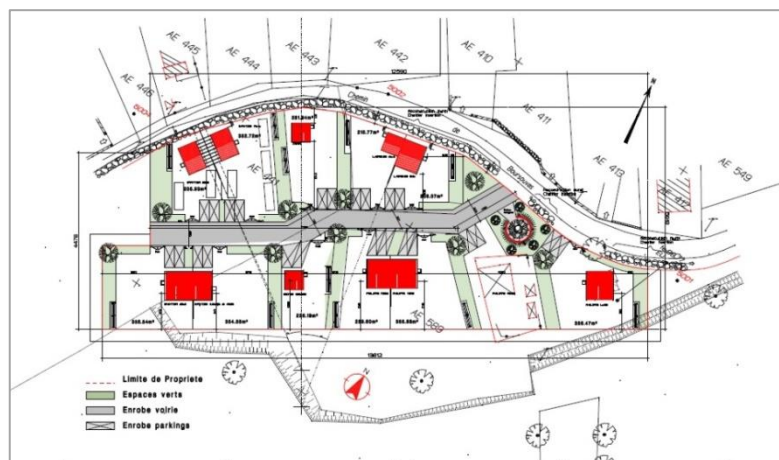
Plan masse du terrain familial locatif de Neschers (63) / Source AGSGV 63
